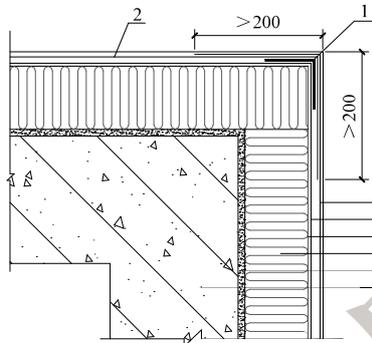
外墙阳角部位的增强（尺寸单位：mm）
